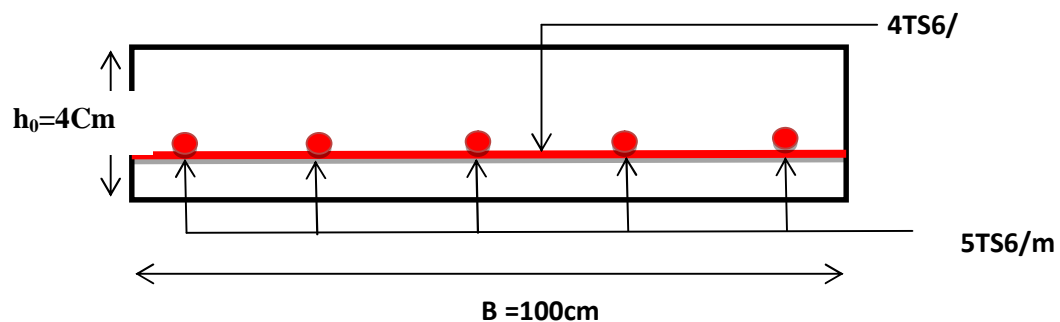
Schéma de ferrailage de la dalle de compression.
